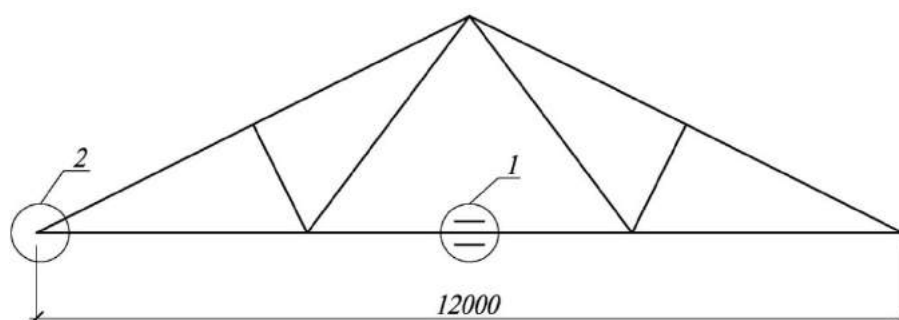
Геометрическая схема фермы пролетом 12 м: 1 – стык нижнего пояса; 2 – опорный узел
